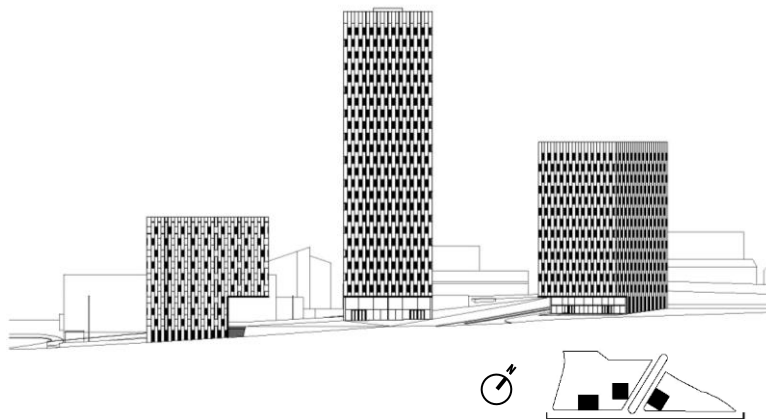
MOURA, Eduardo Souto, Terradas Arquitectos, *La Pallaresa*, Barcelona, 2004/11. Alçado de conjunto e Planta de Implantação, sem escala. GPS: 41°27'22.94"N | 2°12'20.82"E
